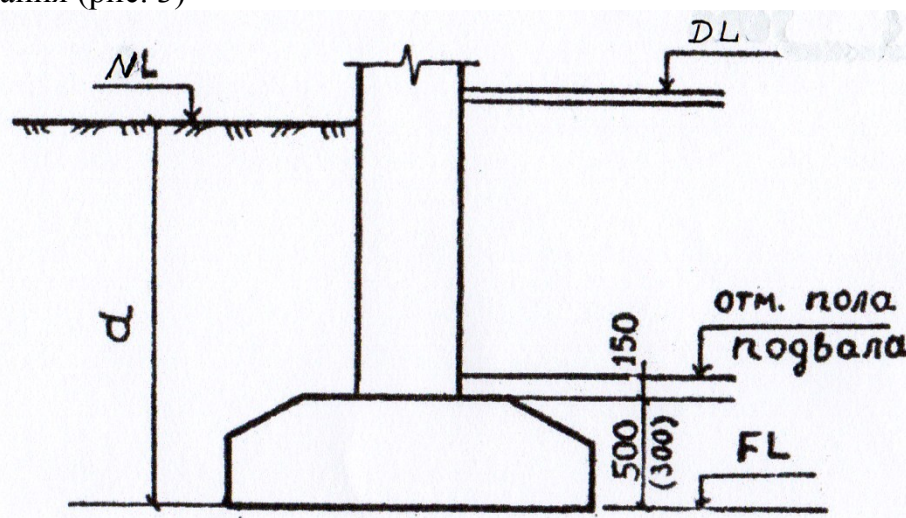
Схема для расчёта глубины заложения подошвы фундамента.
